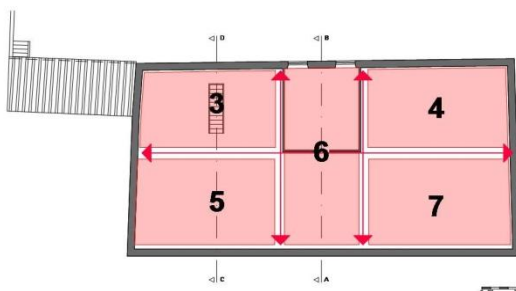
Planta do Sótão - Linhas Estruturantes, Autor, 2017
